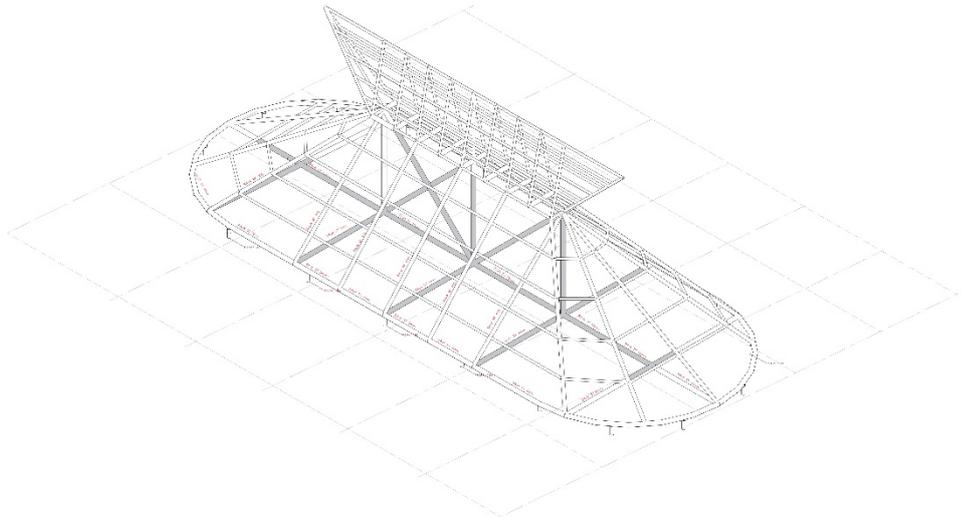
Rencana Kolom Dan Balok Lantai 1
